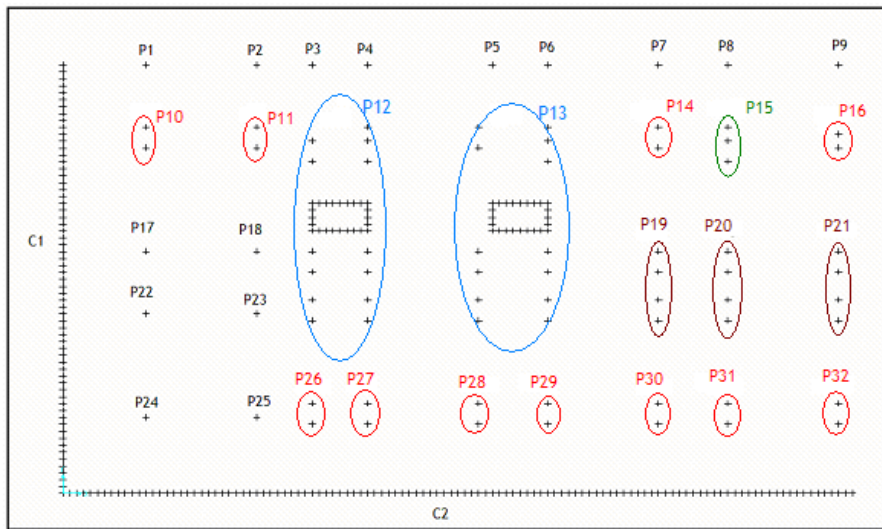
Planta esquemática da posição dos pilares, de acordo com o pormenor da figura 7.
